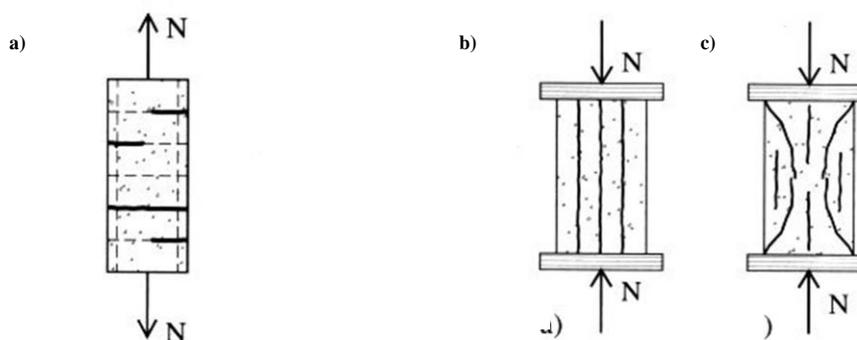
Representação esquemática da fissuração devido ao esforço de tração e compressão (CÁNOVAS, 1988).
